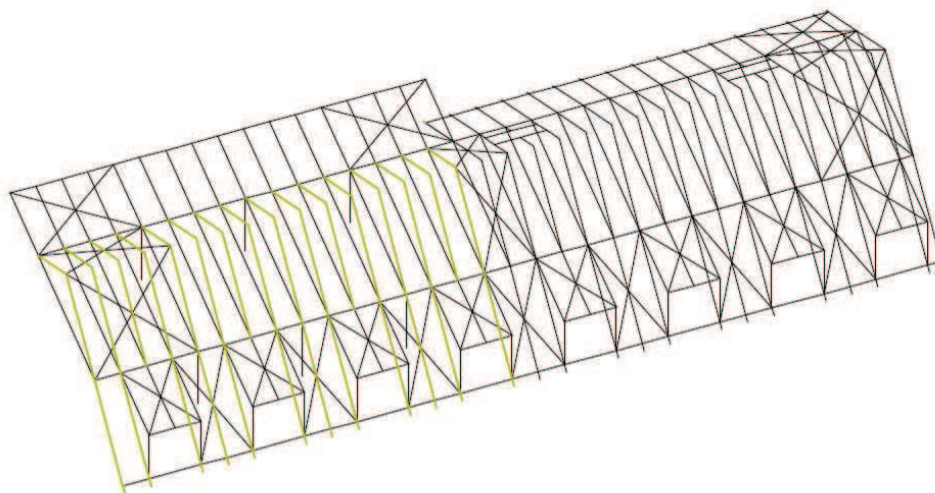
Poloha ztužení pásovinou P.5-20 mm
